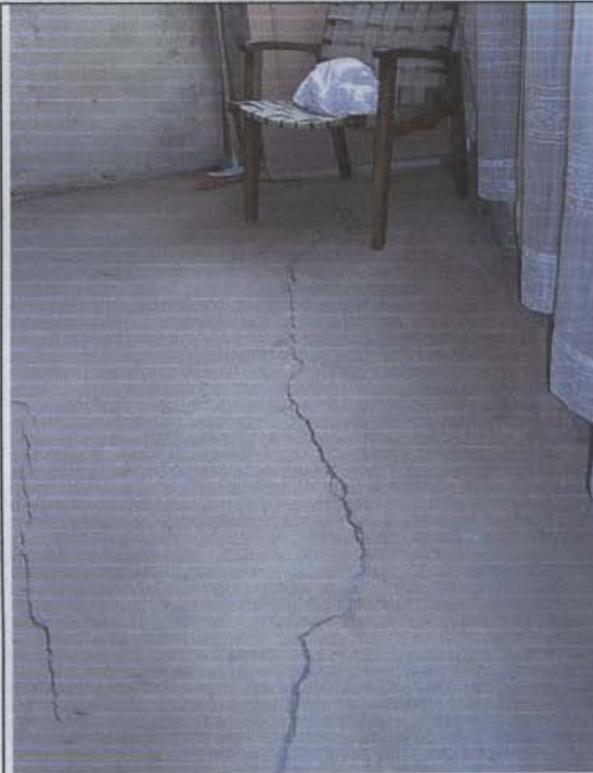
Continuidad de las grietas en el costado sur del inmueble, sector voladizo.
